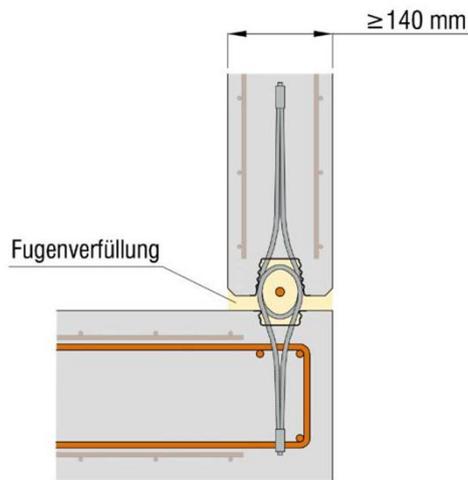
Wand - Wand – Eckverbindung - Regeldetail
